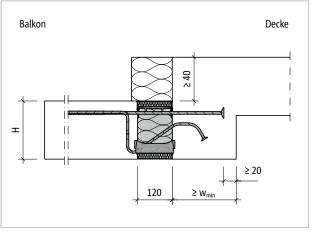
Schöck Isokorb® XT Typ K-U: Balkon mit Höhenversatz nach unten und Außendämmung
